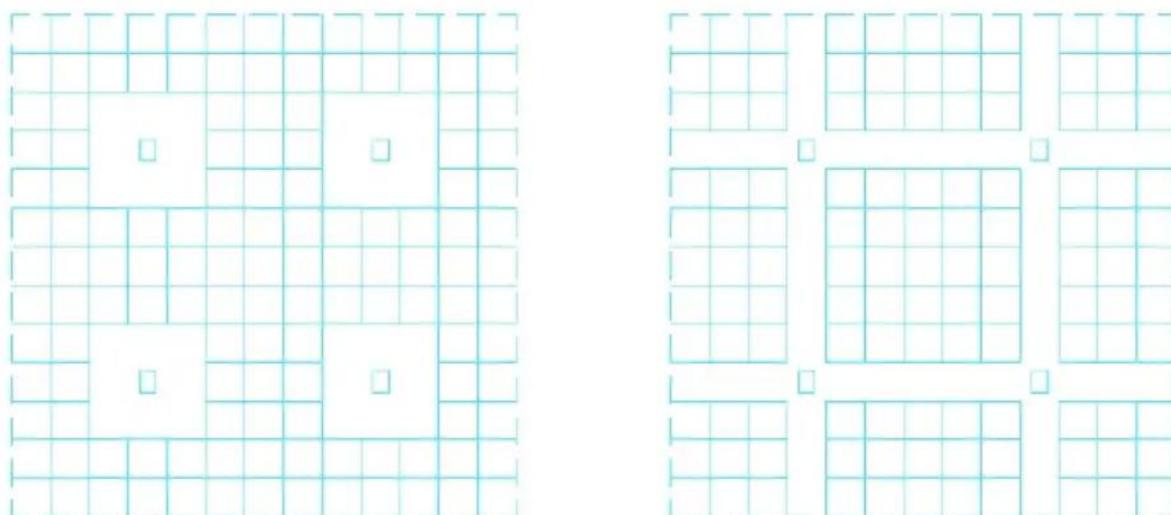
Вафельная плита. Типы опор (в колоннах и балках)
